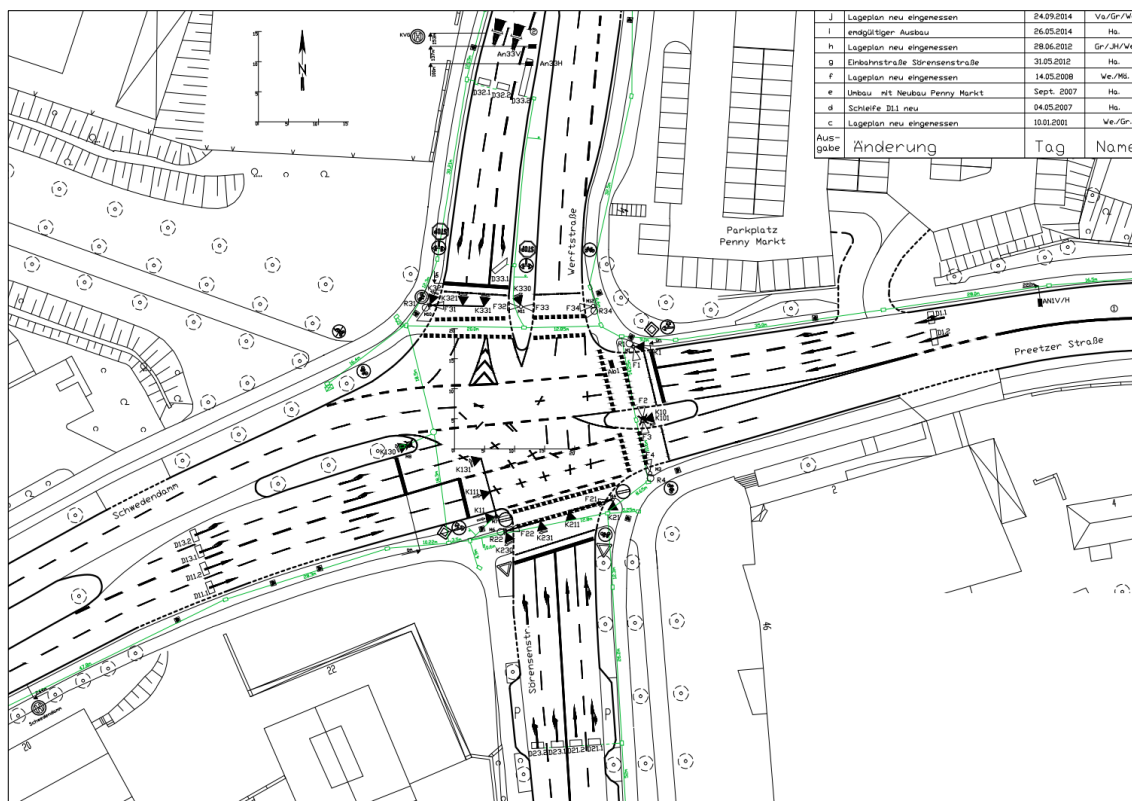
Knotenpunkt Schwedendamm/Werftstraße – Signallageplan [16]
